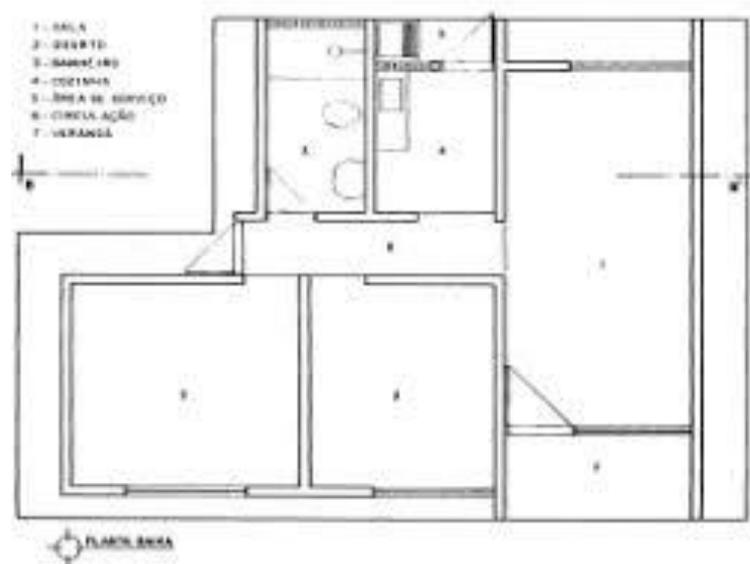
Planta baixa de apartamento no Conjunto Japiim, Manaus – AM.
